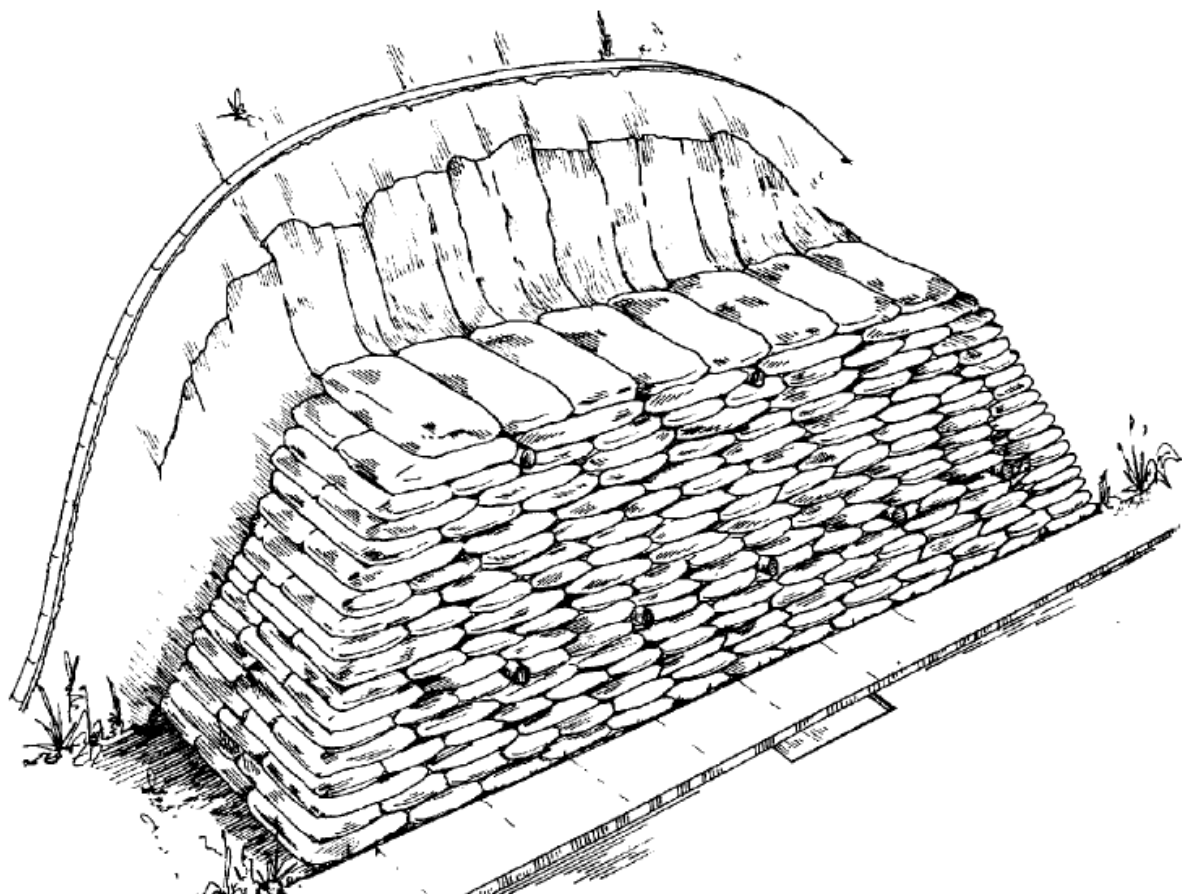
Ilustração de estabilização de talude com solo cimento ensacado. Fonte: ABCP (1996).
